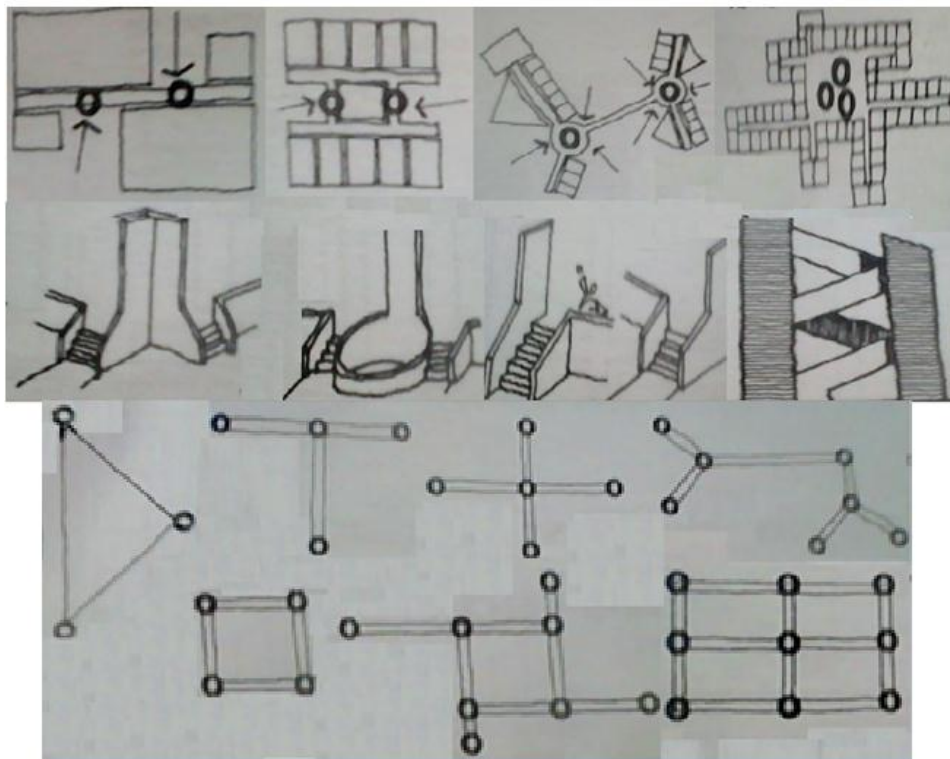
ubicación de las escaleras en planta (los círculos muestran las posiciones recomendadas para las escaleras en edificaciones).
